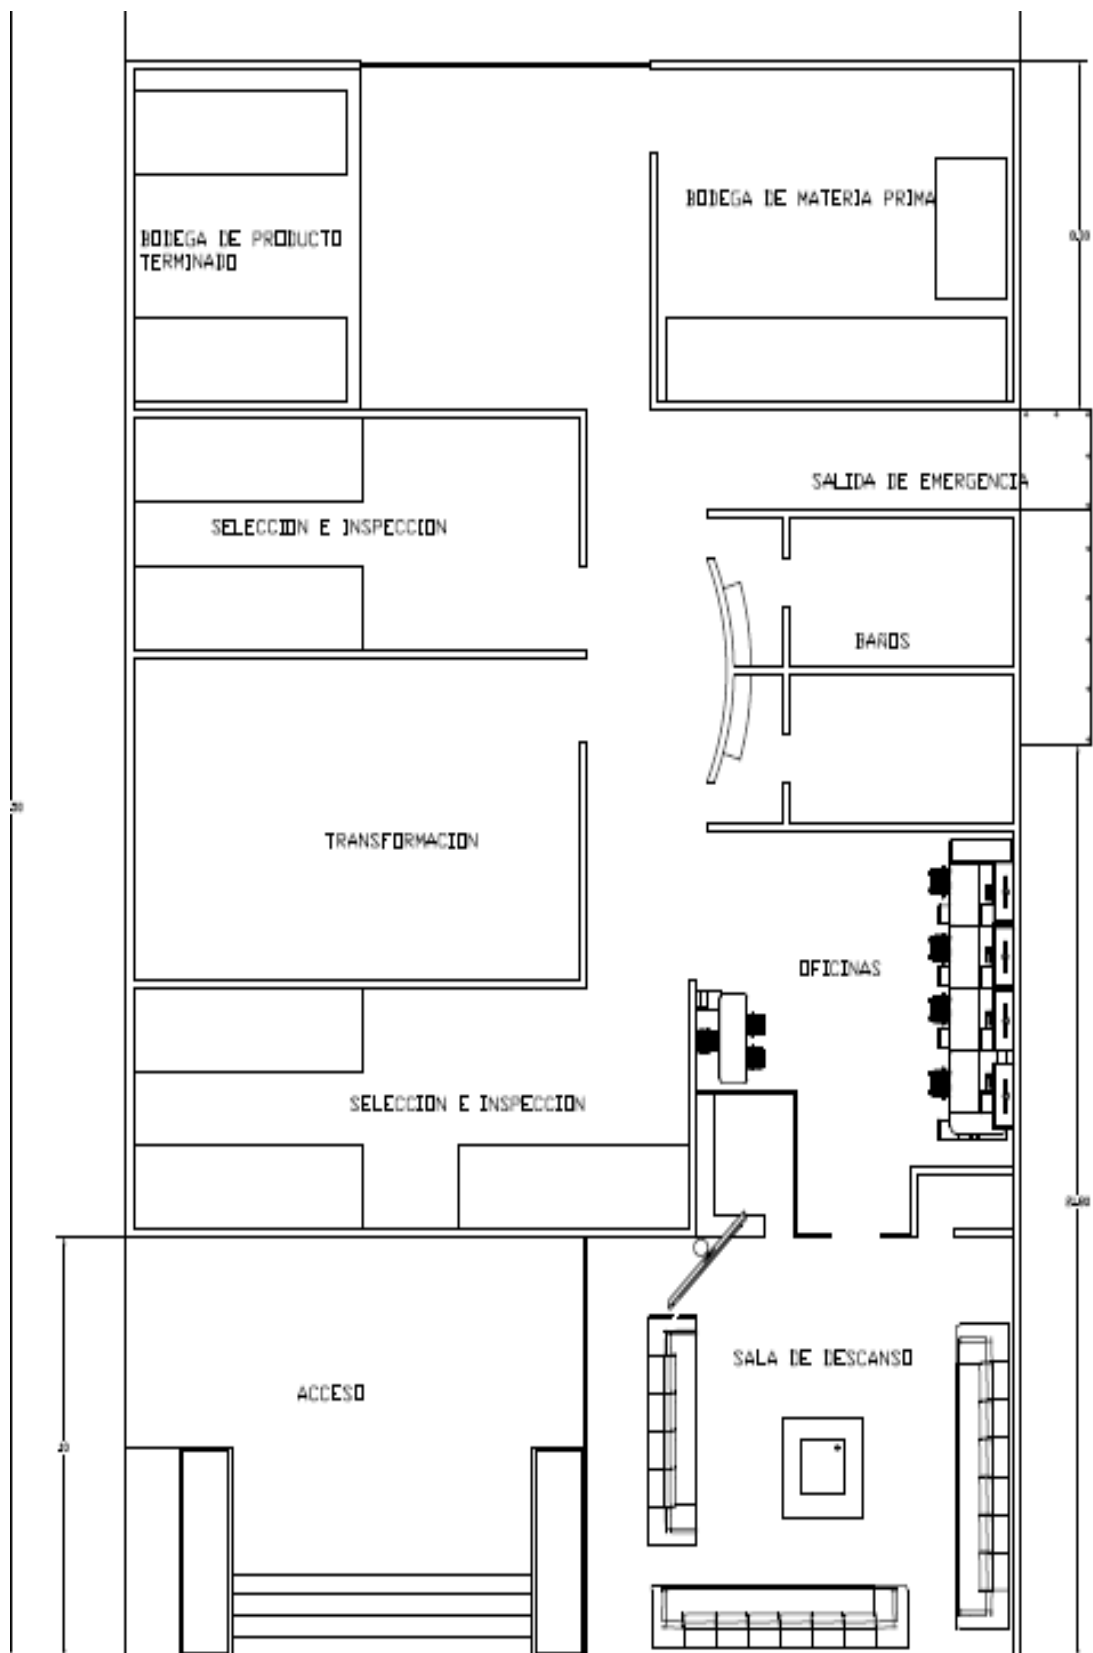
Distribución de áreas de la Planta AYM GOLDEN SAC
